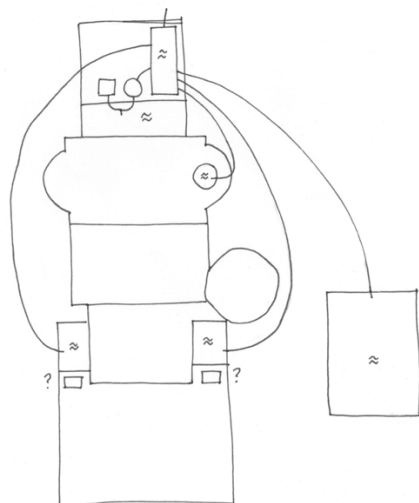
Overzicht waterverdeling badhuis (schets: auteur)
